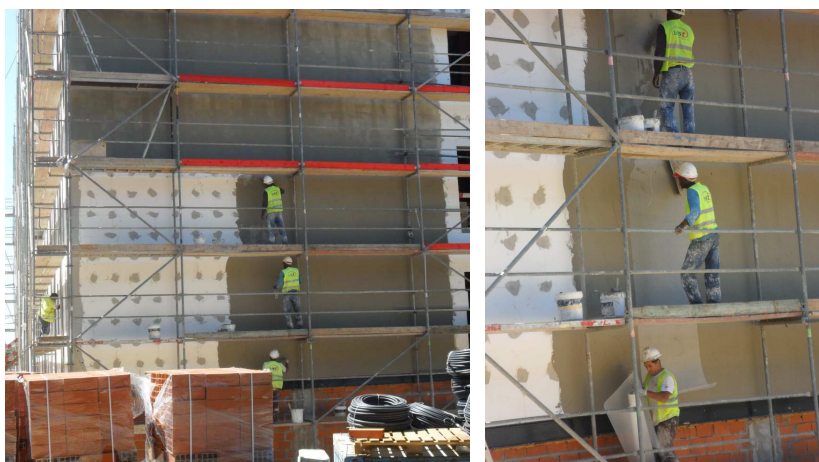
Execução do 1º barramento e colocação da rede de fibra de vidro
